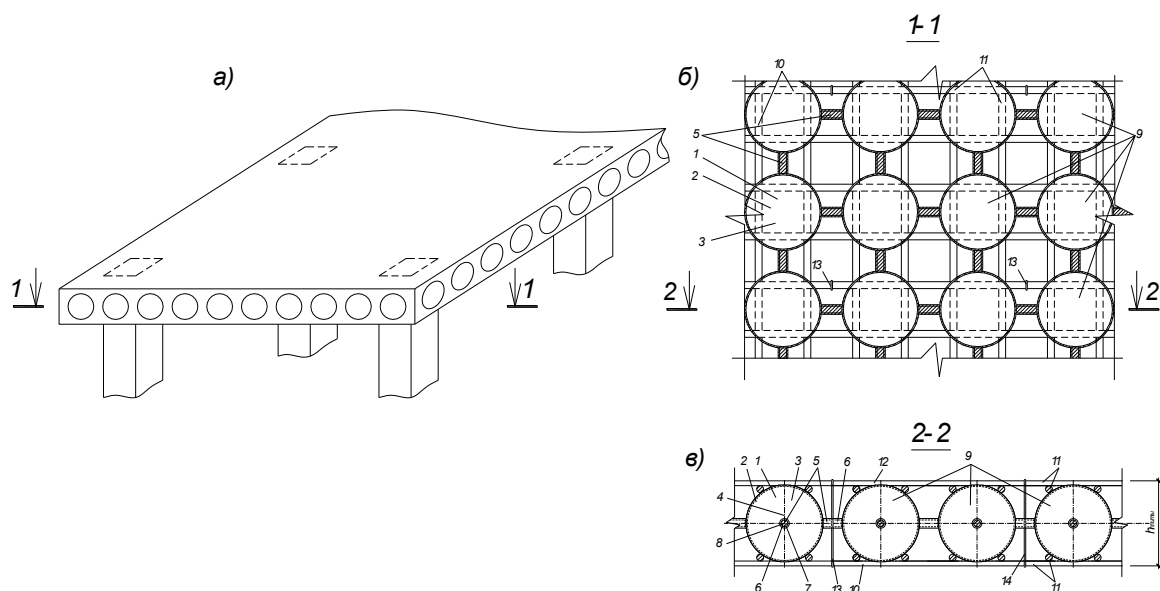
Монолитное перекрытие с применением VST-технологии (а – общий вид плиты перекрытия; б – разрез 1-1; в – разрез 2-2): 1 – пустотообразователь; 2 – тело вращения; 3 – шар; 4 – ось вращения; 5 – фиксаторы; 6 – втулки; 7 – штыри; 8 – центр тела вращения; 9 – блок пустотообразователей; 10 – нижняя арматурная сетка; 11 – арматурные стержни; 12 – верхняя арматурная сетка; 13 – хомуты
